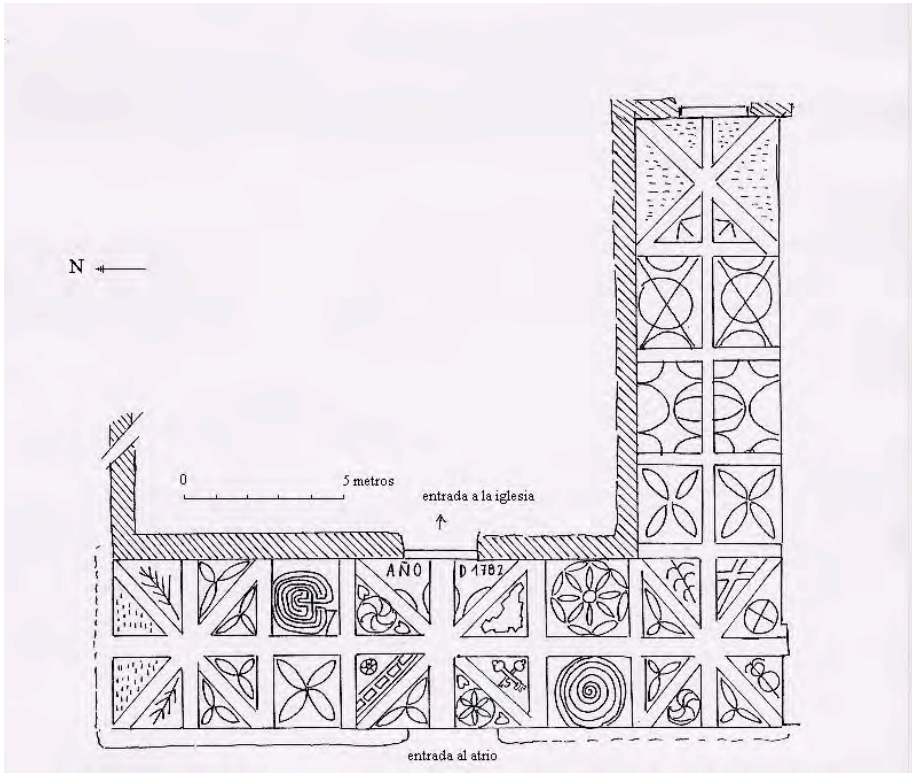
Plano del empedrado de Santa María de Arrankudiaga
